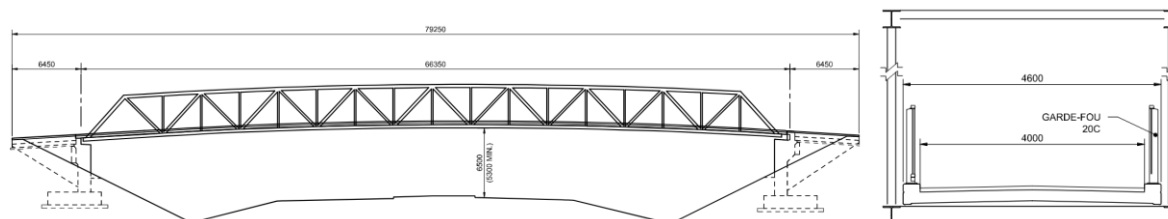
Pont à poutres triangulées à tablier inférieur
